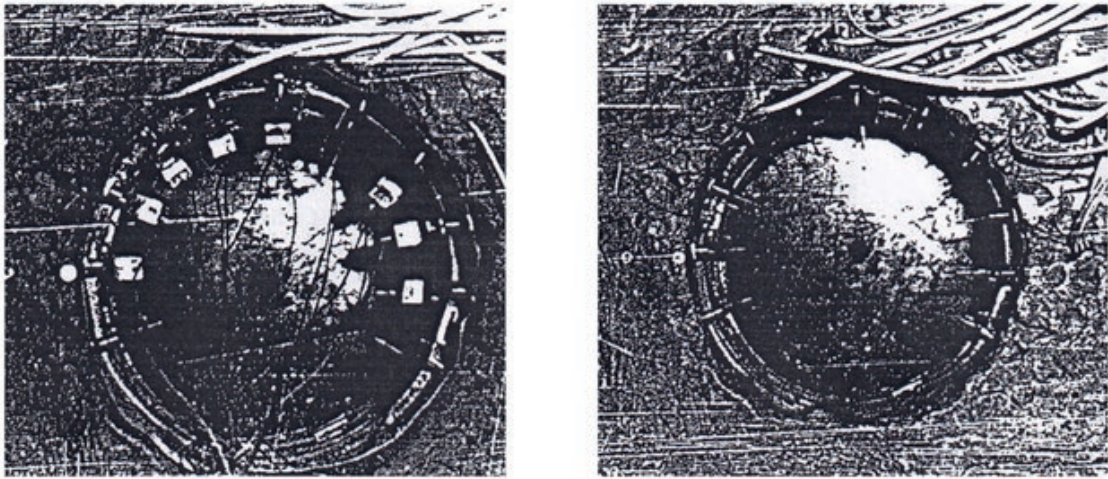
Модель выработки, закрепленной крепью АМК: а – до испытаний; б – после испытаний
